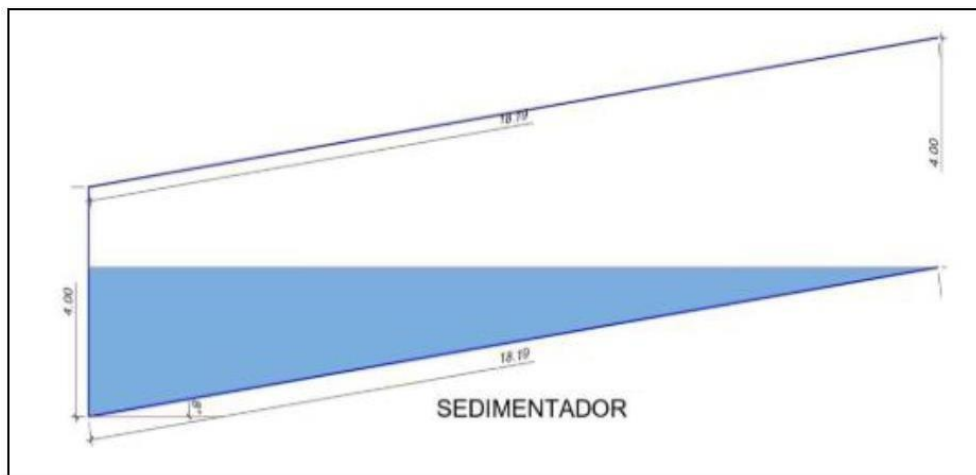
Vista Transversal de la sección de una poza de sedimentación
